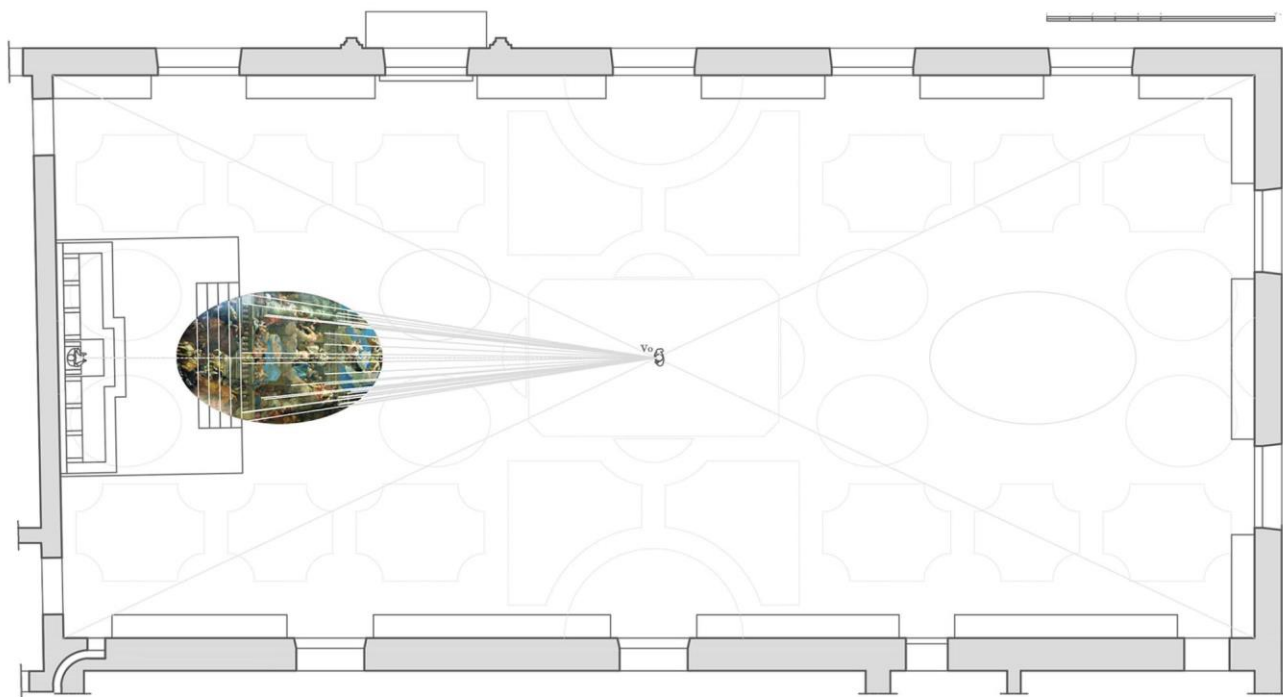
Posizione del punto principale della prospettiva dipinta sul telaio (elaborazione di Silvia Masserano).
